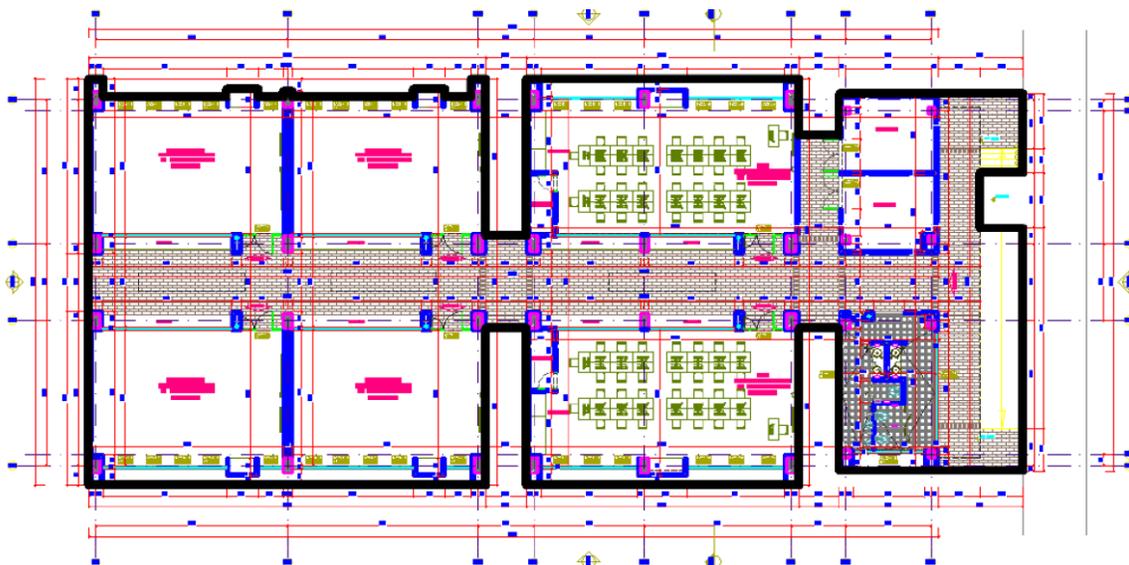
Planta nivel 1. Unión temporal SENA (2019).
